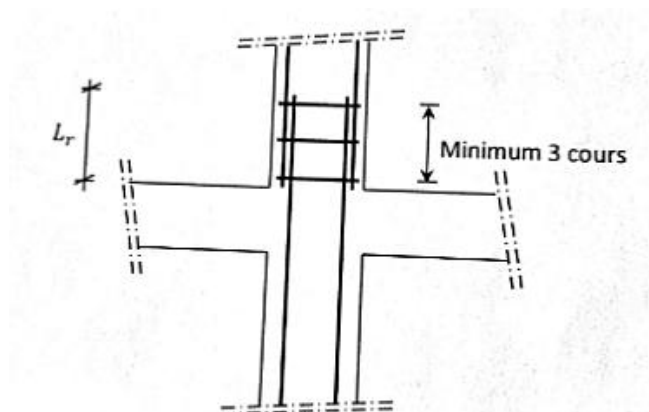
Les armatures transversales dans la zone de recouvrement
